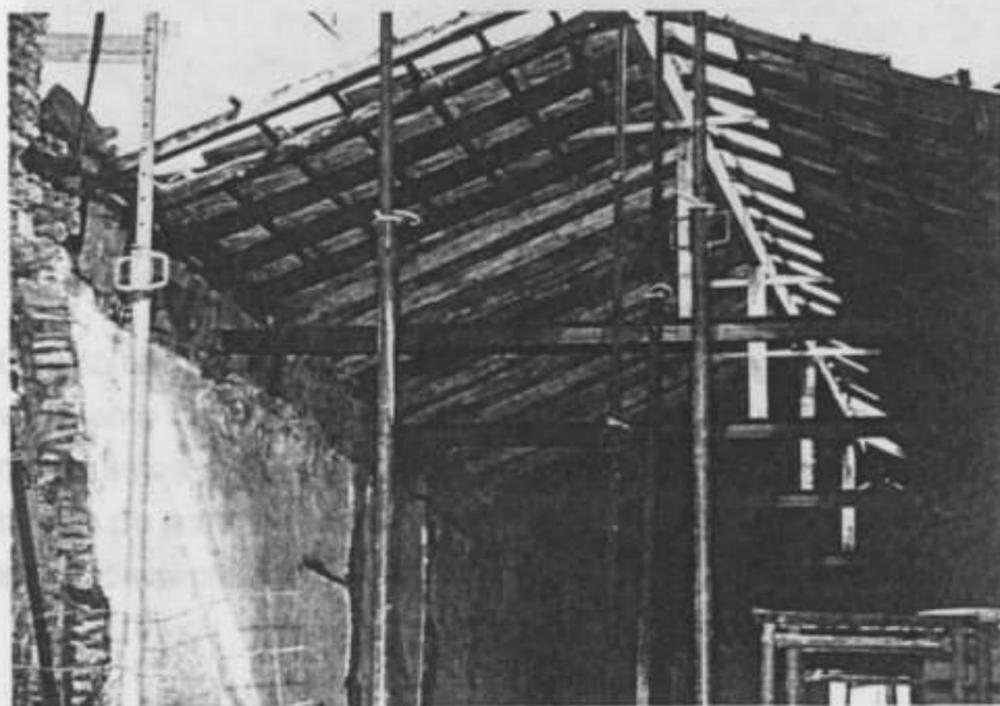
Vigas metálicas que, em obra recente, substituíram a estrutura em madeira
